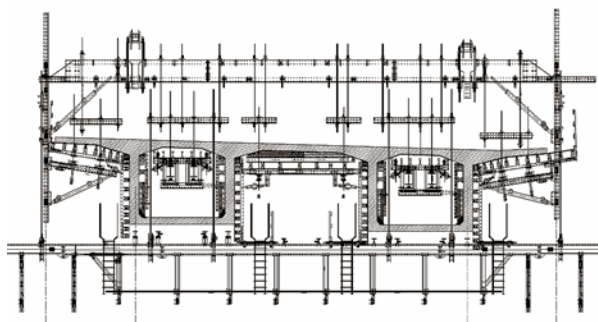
Pierwsze w Polsce użycie kompletnego systemu PERI VBC w technologii betonowania wspornikowego – MA 78 autostrada A4.
